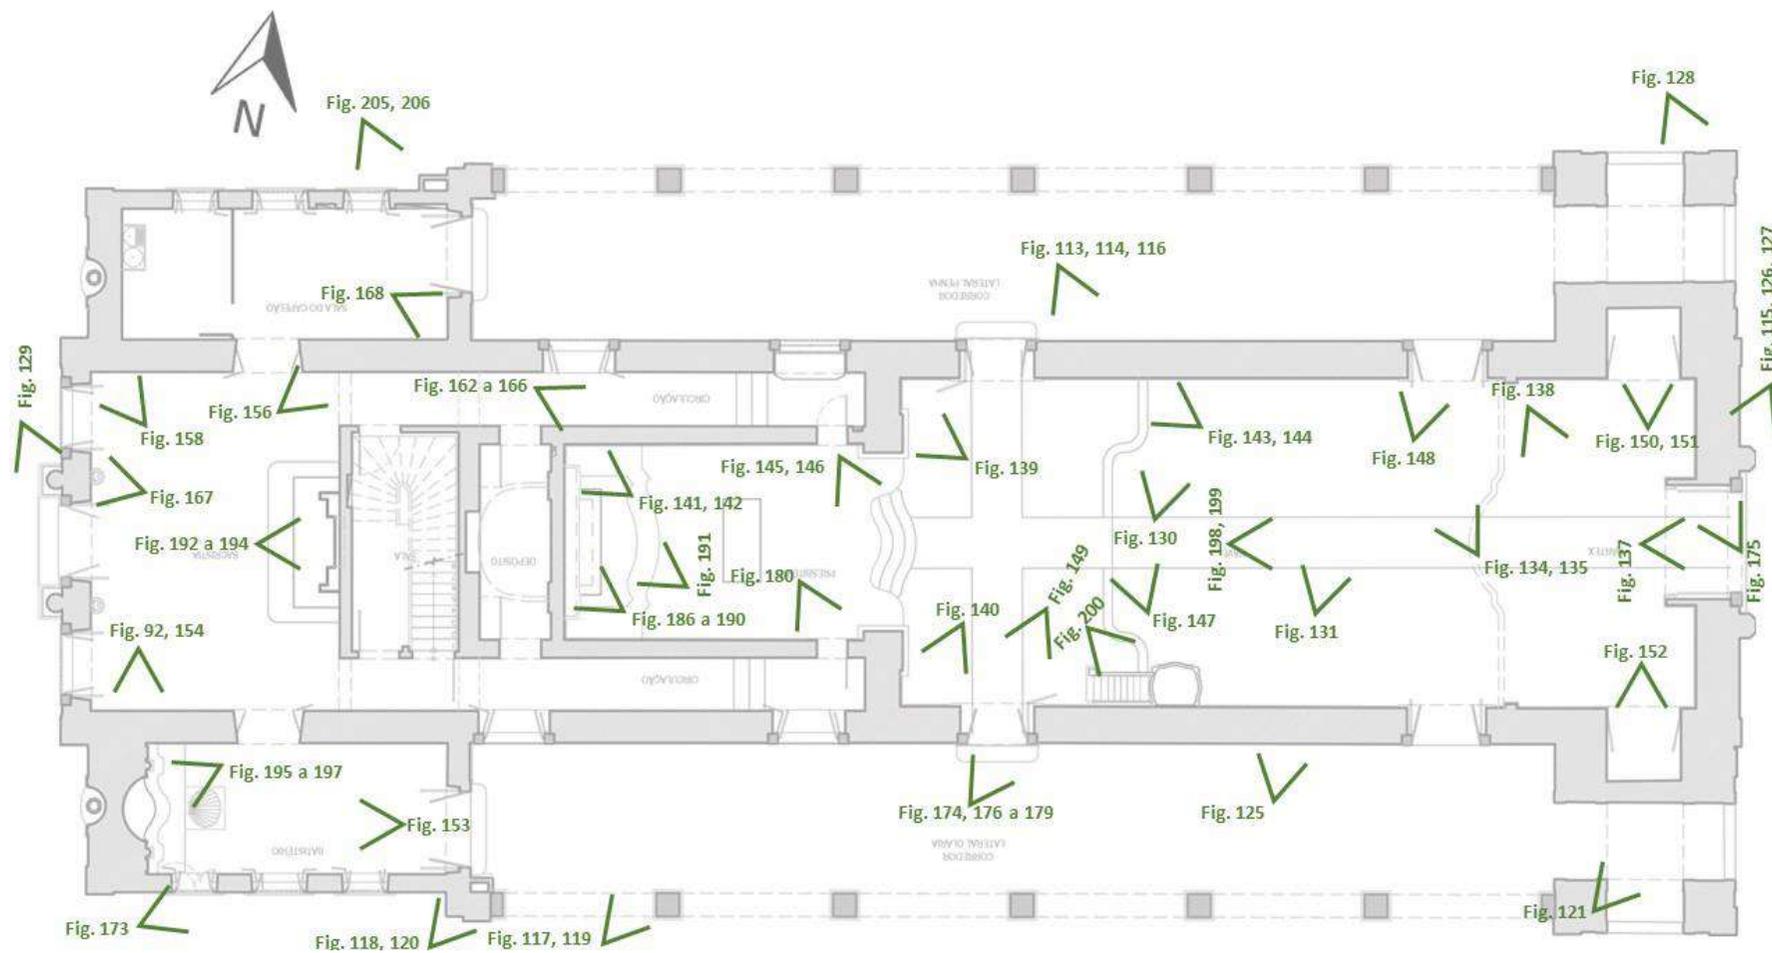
localização das figuras presentes no capítulo Diagnóstico de Conservação, pavimento térreo.
